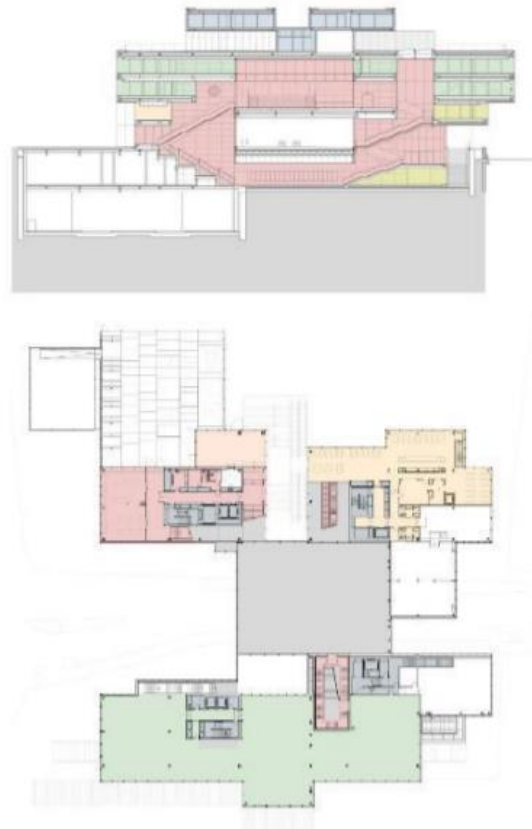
Sección y planta – Distribución de funciones BLOX. Fuente: OMA Studio
